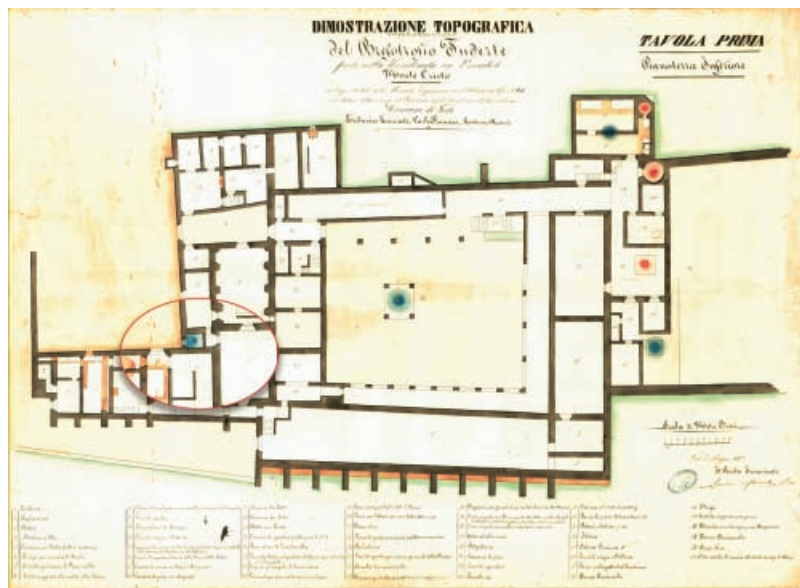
Planimetria del 1862 di Alejandro Astancolle
